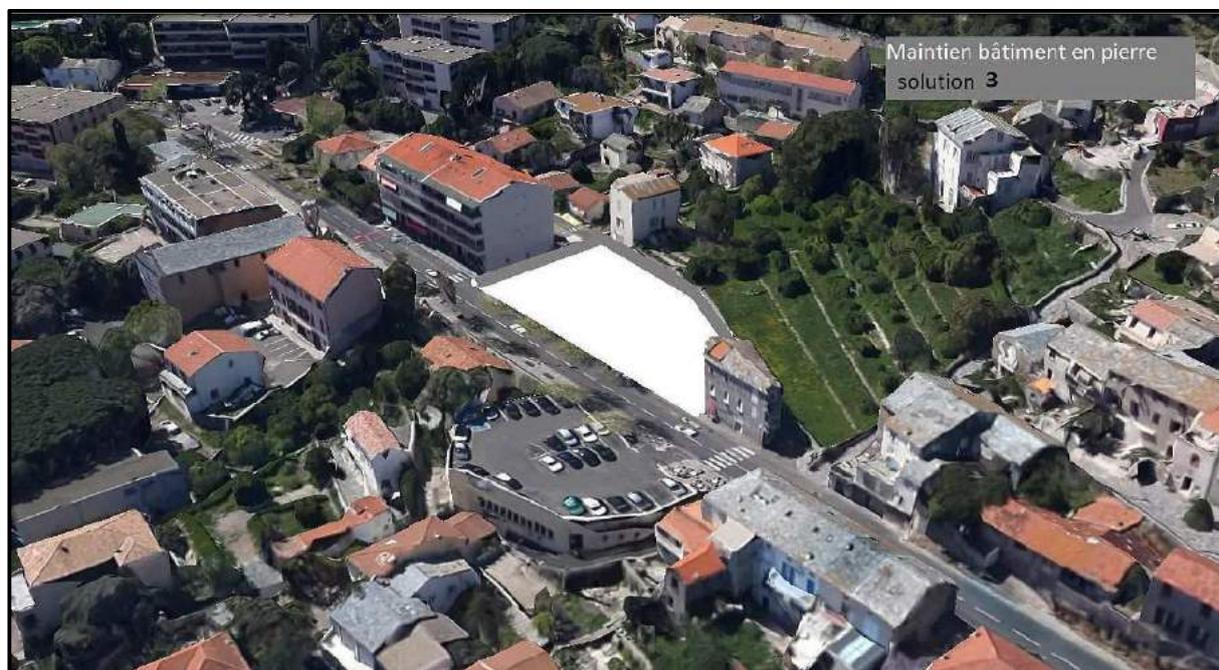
Solution 3 - Maintien du bâtiment en pierre
